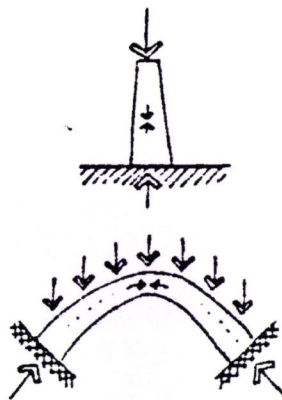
Família estrutural tipo – Compressão ¹
